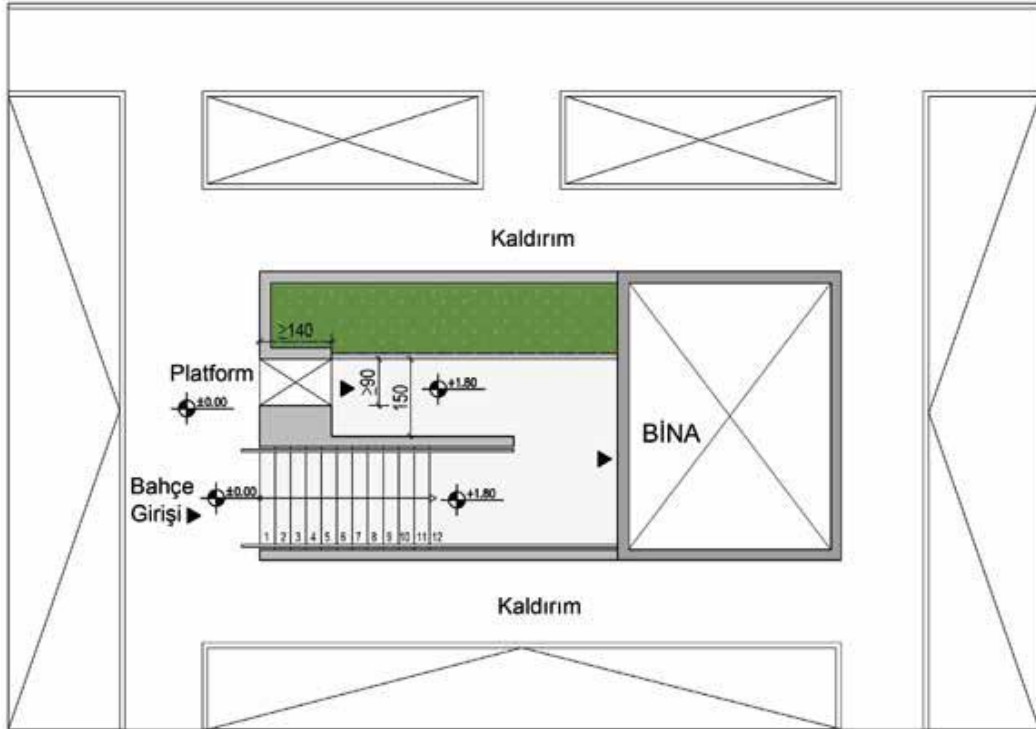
Bahçe Girişinde Rampa Uygulaması
